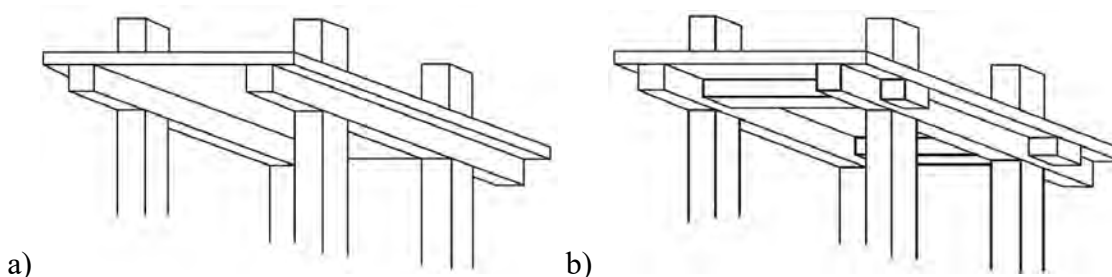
a) Losa unidireccional, b) losa en dos direcciones (figuras tomadas del libro “Diseño de concreto” R. McCormac)
